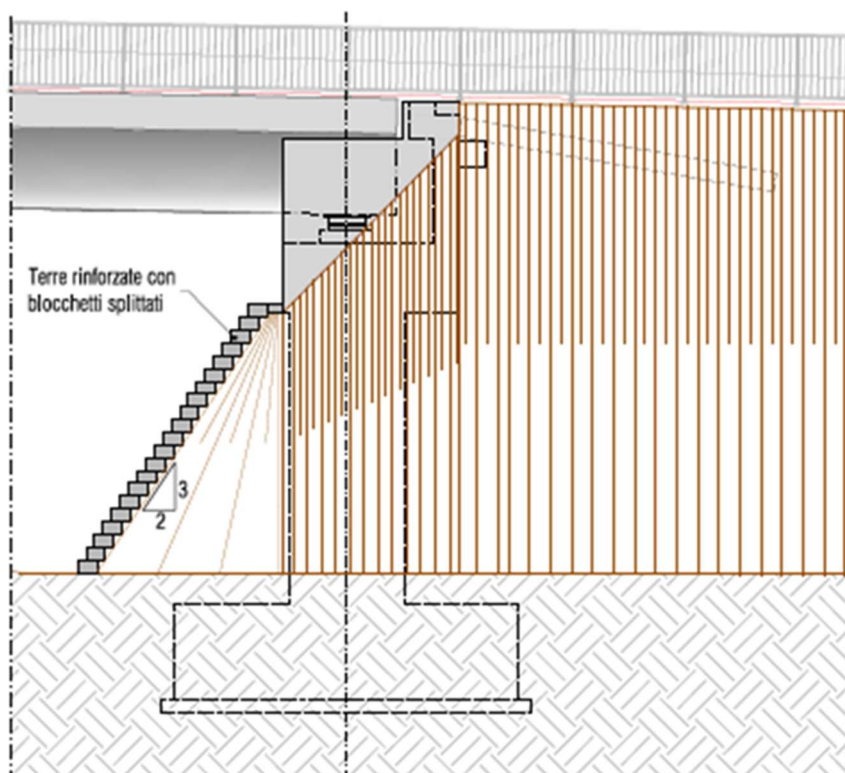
RIVESTIMENTO SPALLE CAVALCAVIA CALVECCHIA IN BLOCCHETTI SPLITTATI
